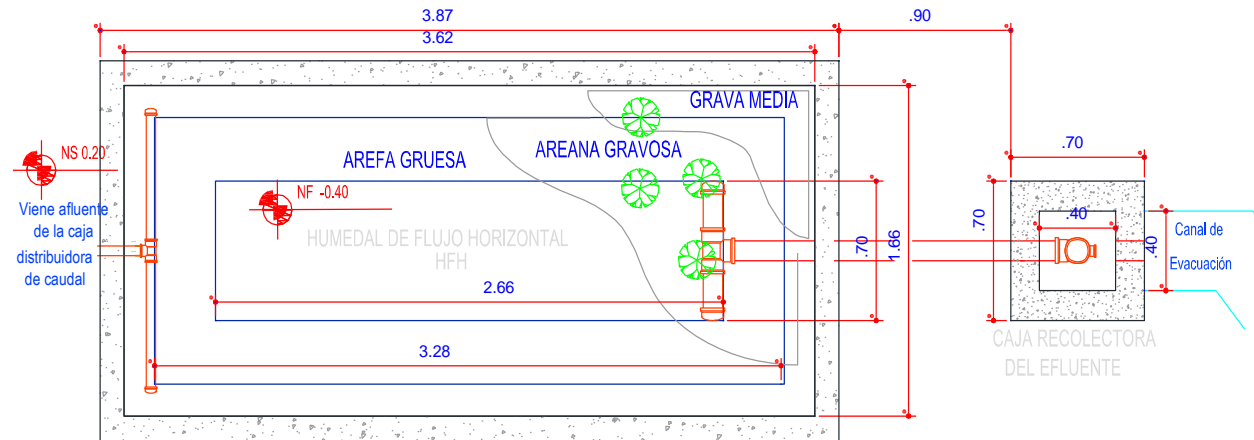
Plano diseñado en planta del Humedal de Flujo Horizontal.
